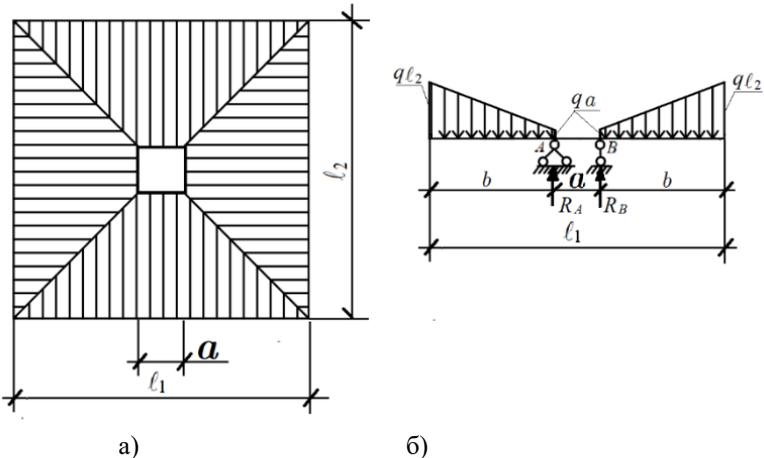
Схема розподілу навантаження для надколонної плити: a – розподіл навантаження на плиту; b –розрахункова схема
